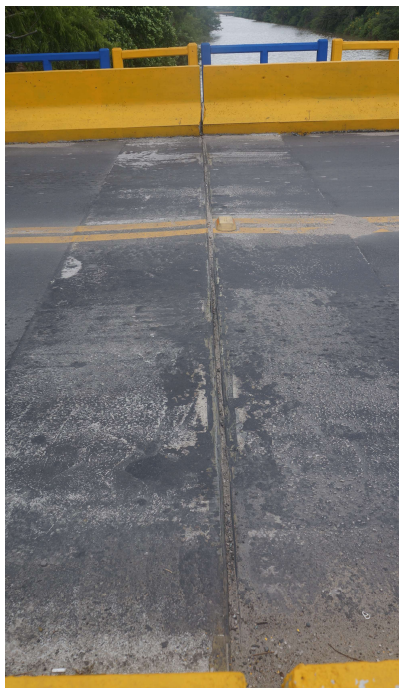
17/10/2017	Vista da junta de dilatação na pista.
